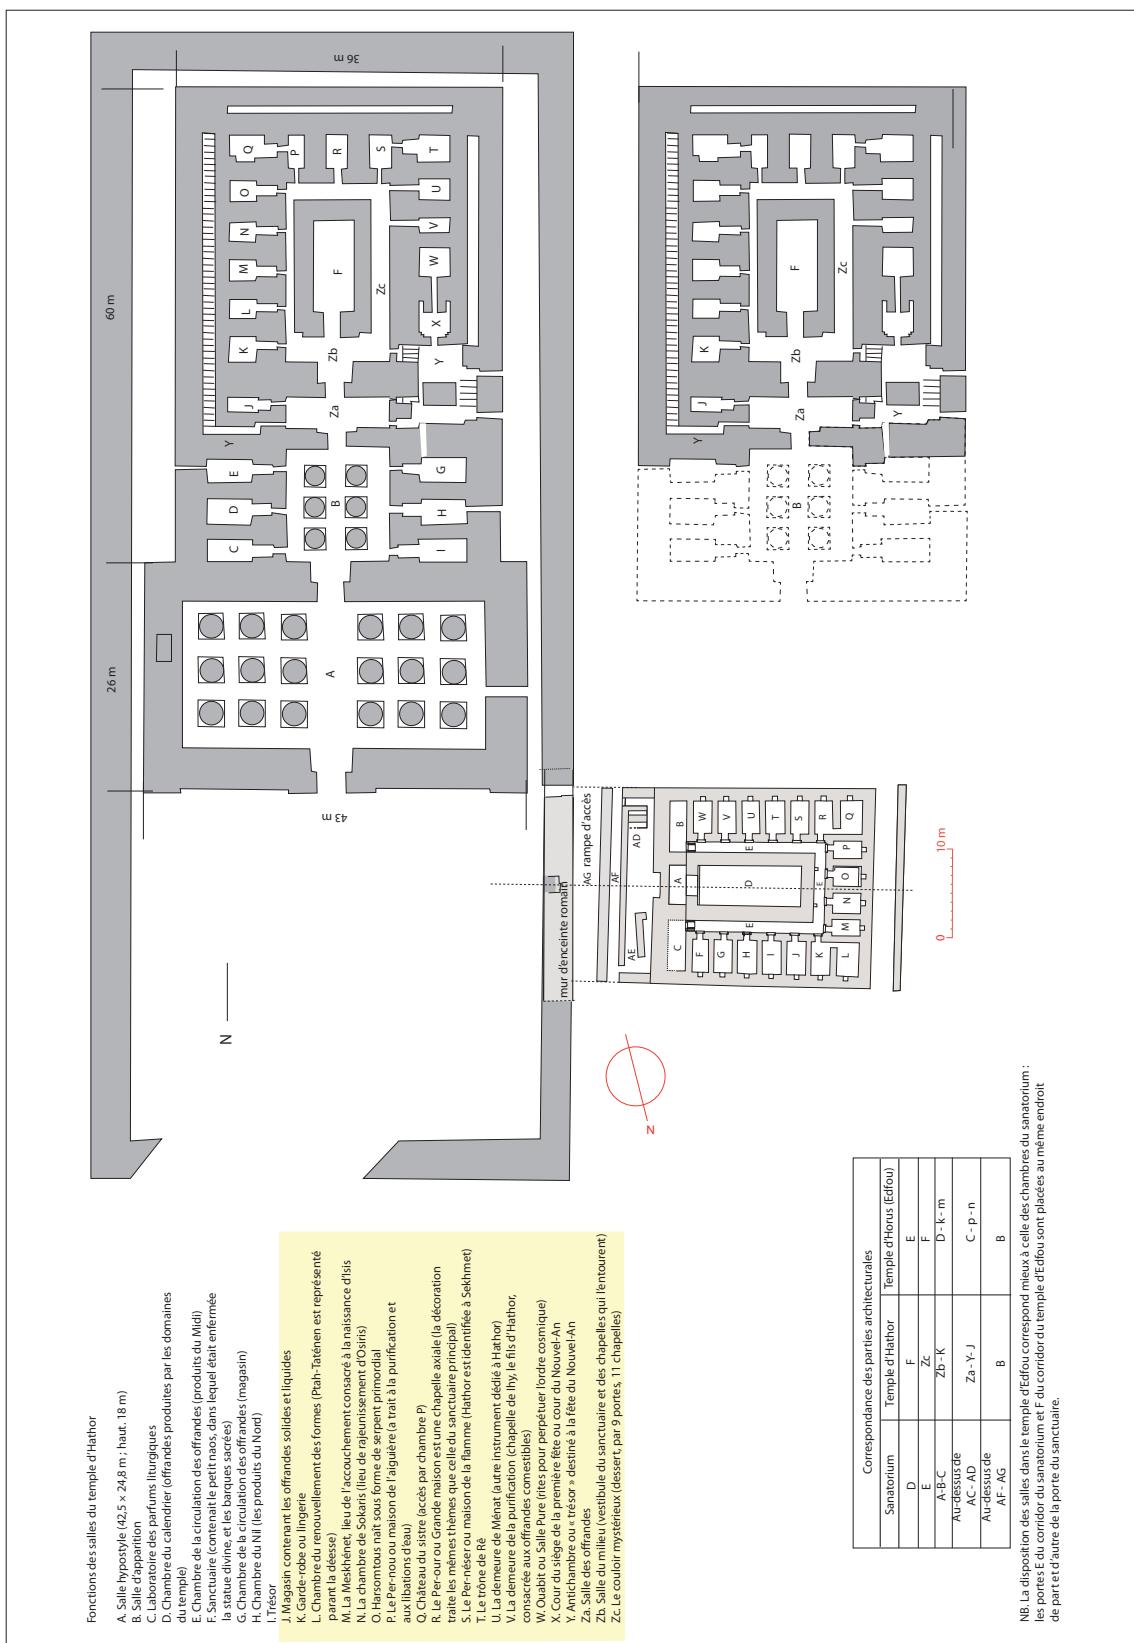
Plan du temple d'Hathor : parties du temple (en gris) pouvant correspondre aux salles du sanatorium.
